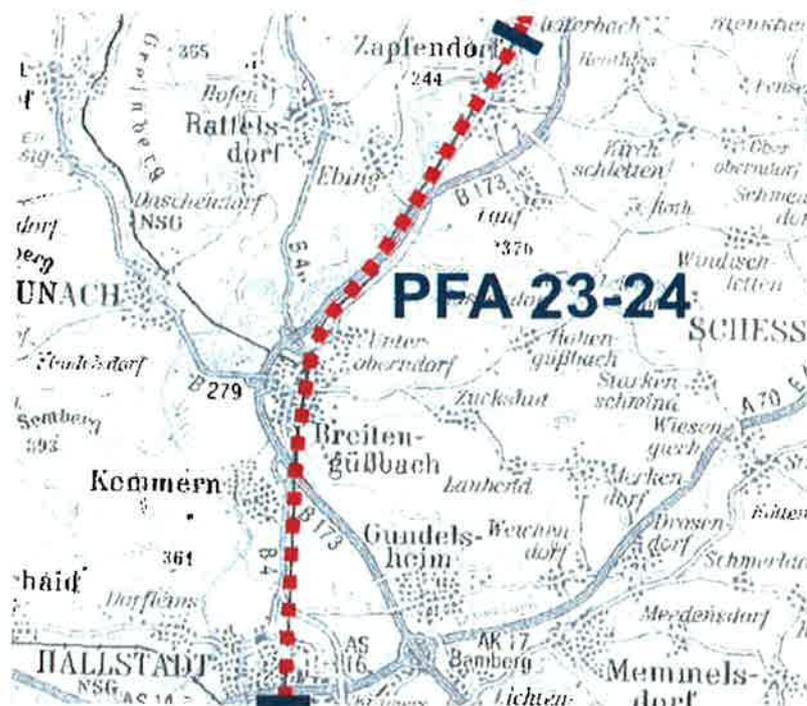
Darstellung des PFA 23-24 Hallstadt - Zapfendorf
